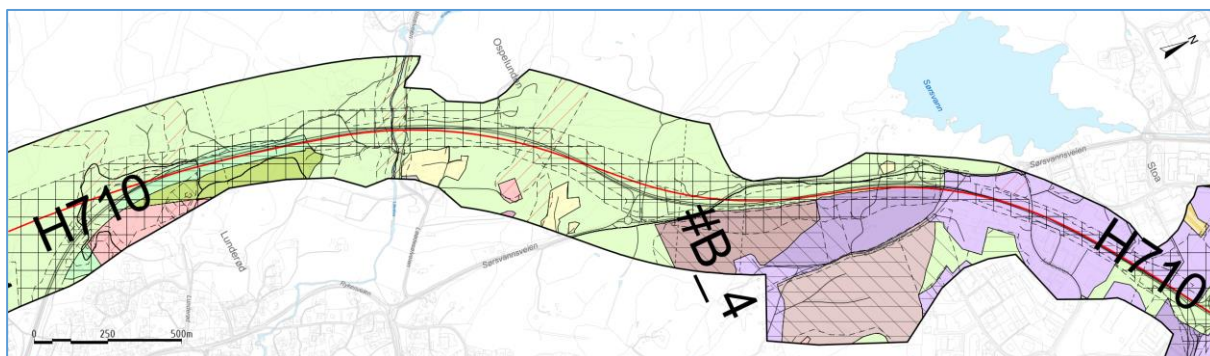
Forslag til endret kommunedelplan på delstrekning Harebakken–Sørsvann. (Kilde: Sweco)
